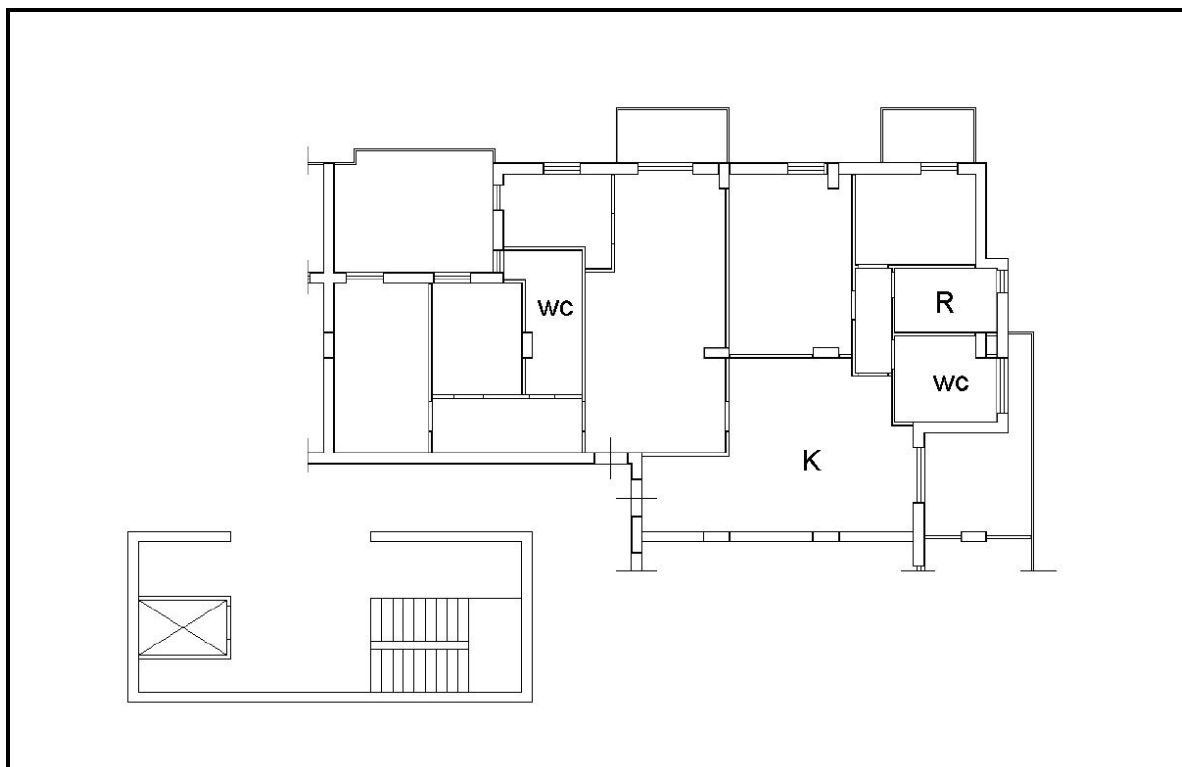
Planimetria catastale dell'appartamento sub 61 sito al piano quarto dell'edificio polifunzionale interno alla particella 1205.
